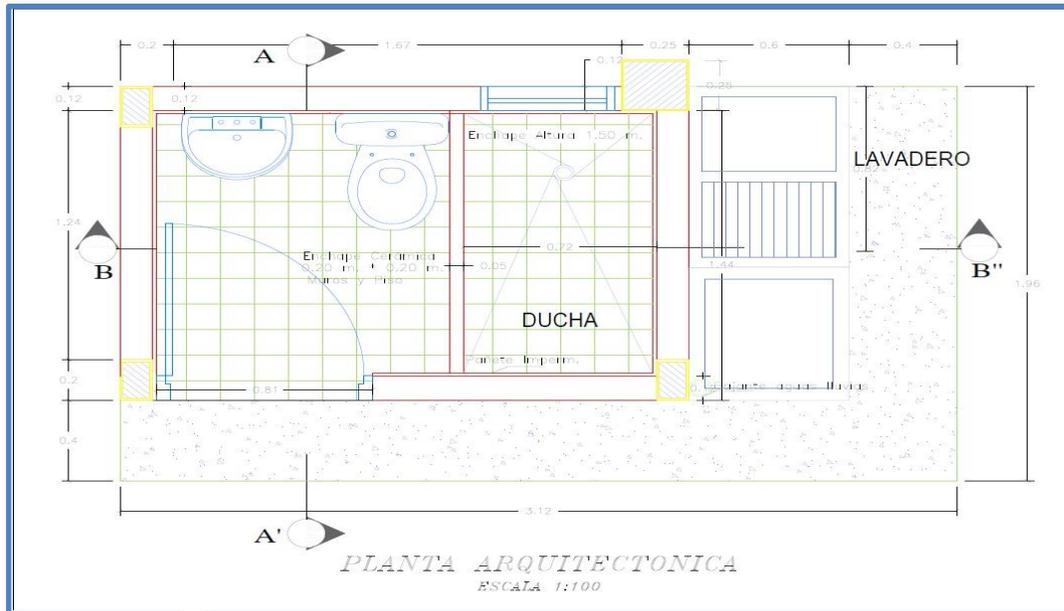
Planta arquitectónica Unidad Sanitaria Fuente: MVCT- Proyecto Tipo DNP
